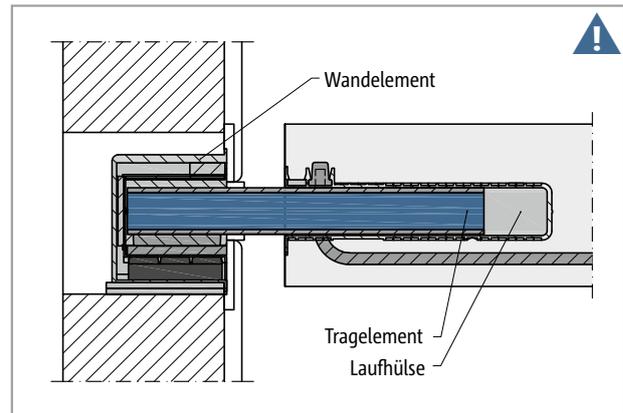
Schöck Tronsole® Typ Q: Mehrteiliges Produkt (Wandelement, Tragelement, Laufhülse); Tragelement (eingefärbt) muss auf der Baustelle eingebaut werden.
